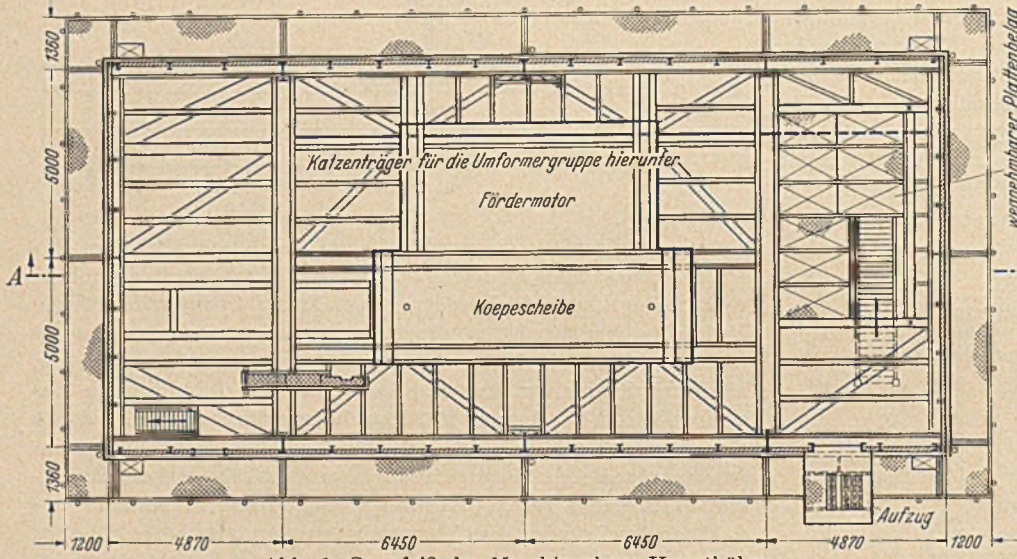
Grundriß der Maschinenhaus-Hauptbühne.
